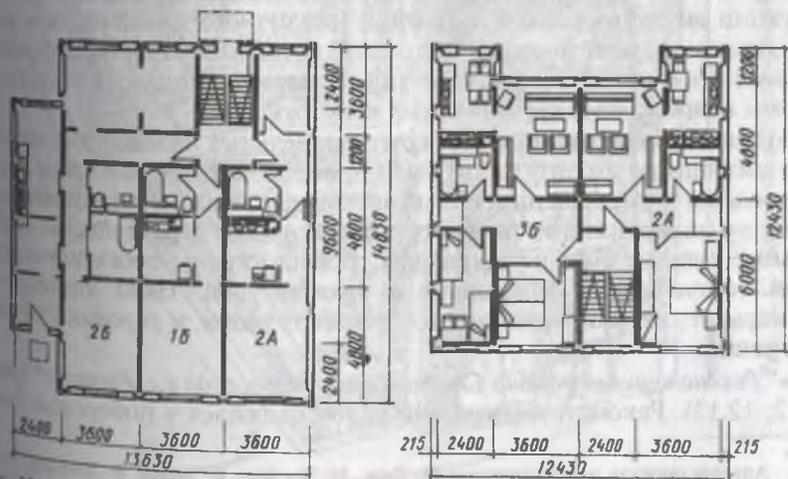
Варианты планировки жилых секций для реконструкции р-на Старого города в г. Росток (Германия)
